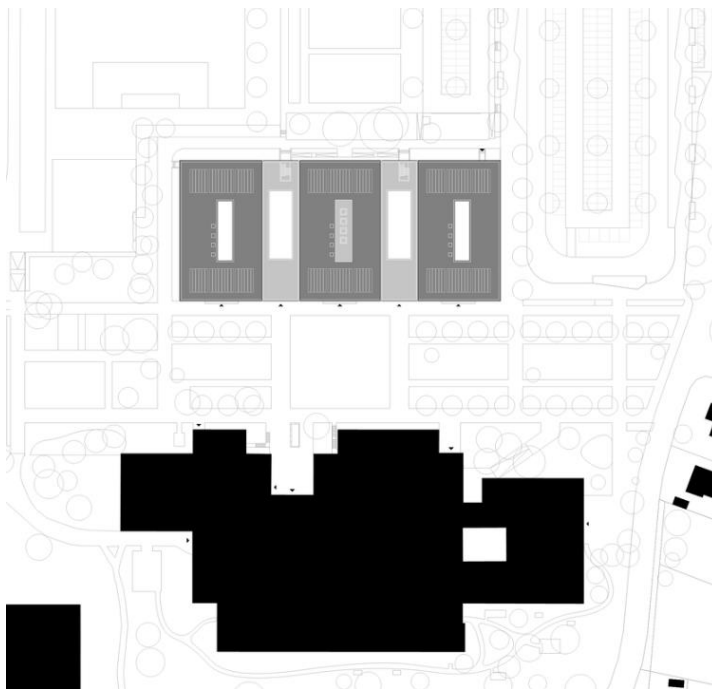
Ситуаційний план із розташуванням нової та старої будівлі [31]
